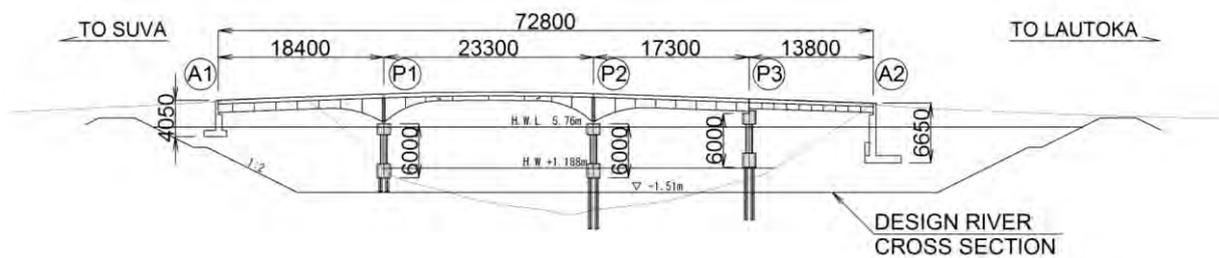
既設橋側面図(Nadi Town Bridge) Source: JICA Study Team
